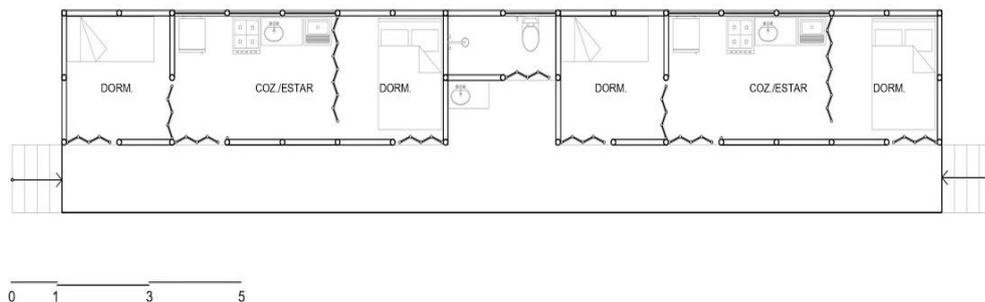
Planta baixa da possibilidade de ampliação da habitação, com mais módulos e varanda. Fonte: elaborado pelos autores.
